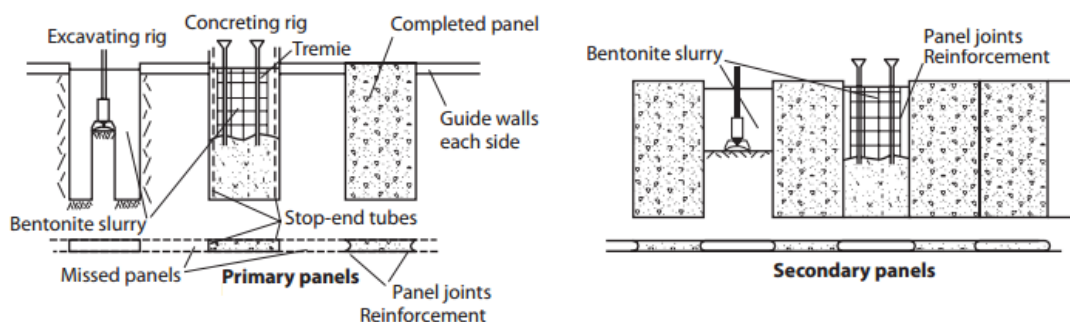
Ilustração do processo construtivo de paredes moldadas. (fonte: *Groundwater Lowering in Construction* [4])
